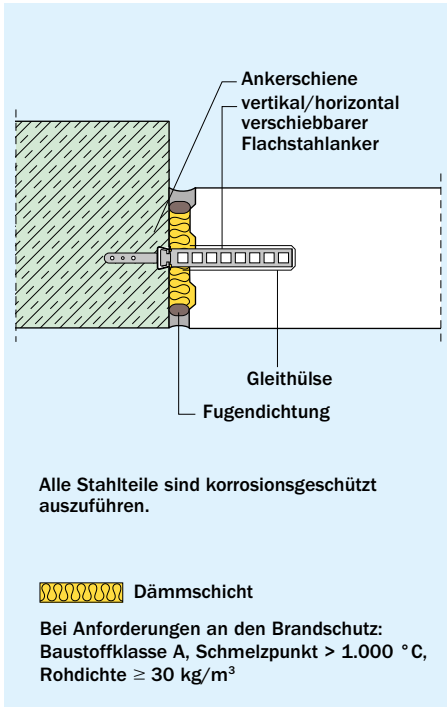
Beispiel für einen gelenkigen Wandanschluss an eine Stahlbetonstütze mit Ankerschienen bei Verwendung von Normalmauermörtel
